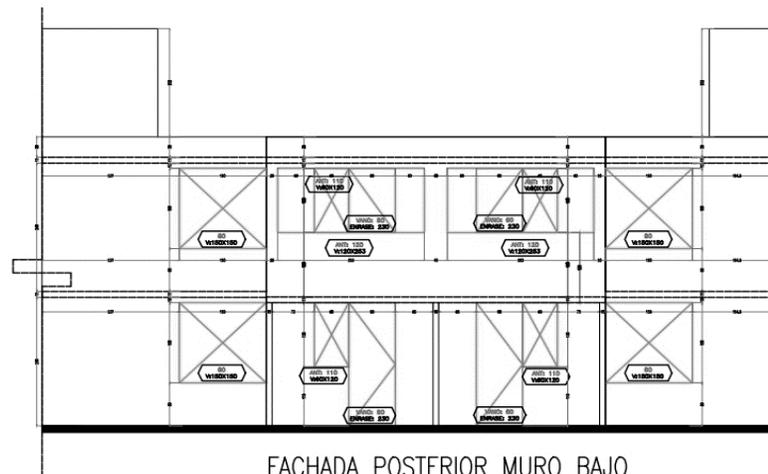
Planos adaptación al proyecto ver en anexo correspondiente de planos
